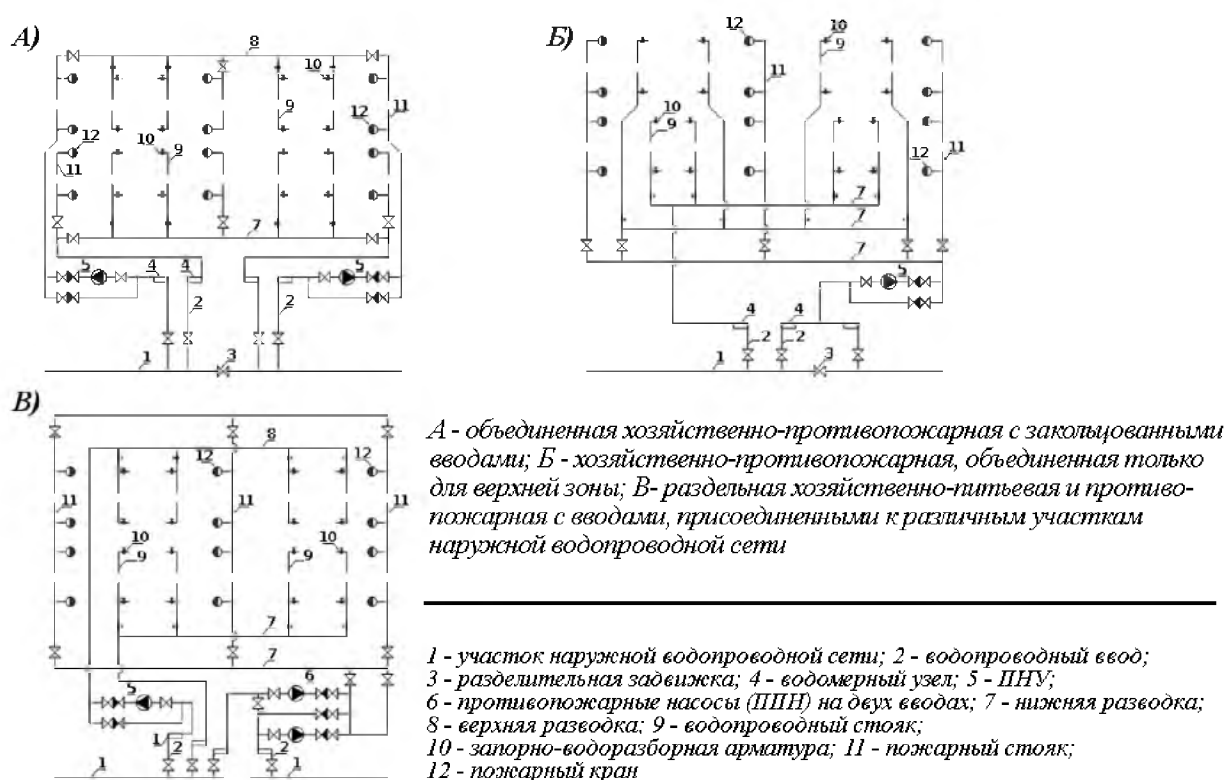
Схемы зонных систем внутренних водопроводов зданий с ПНУ
